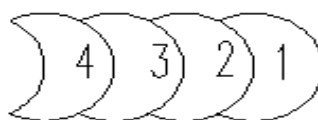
Свайная стена из последовательно пробуриваемых и бетонируемых свай
